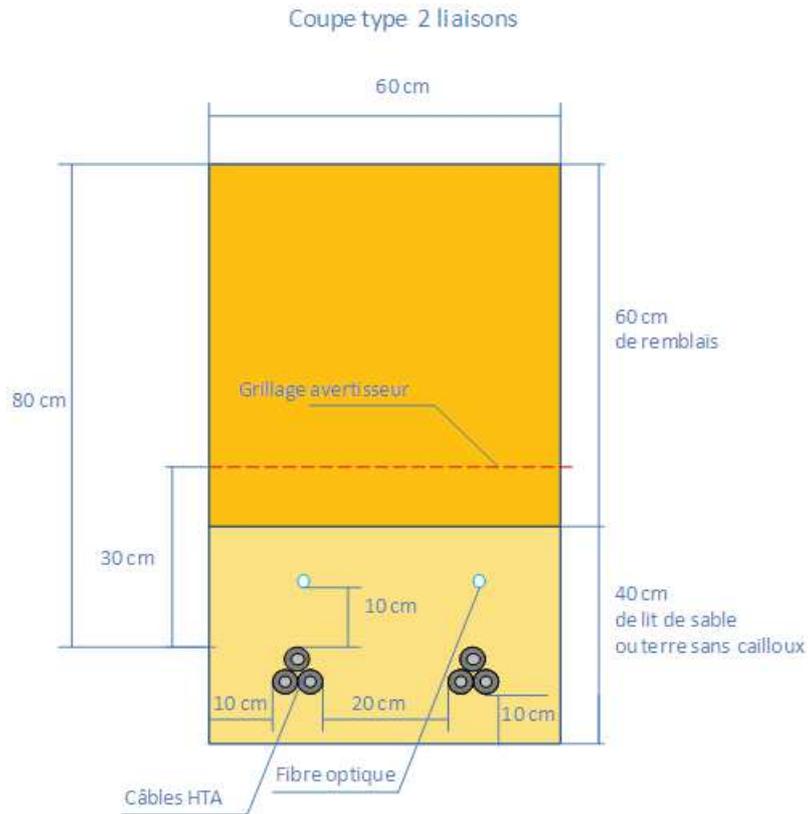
plan coupe d'une tranchée de câblage électrique interéolienne.
